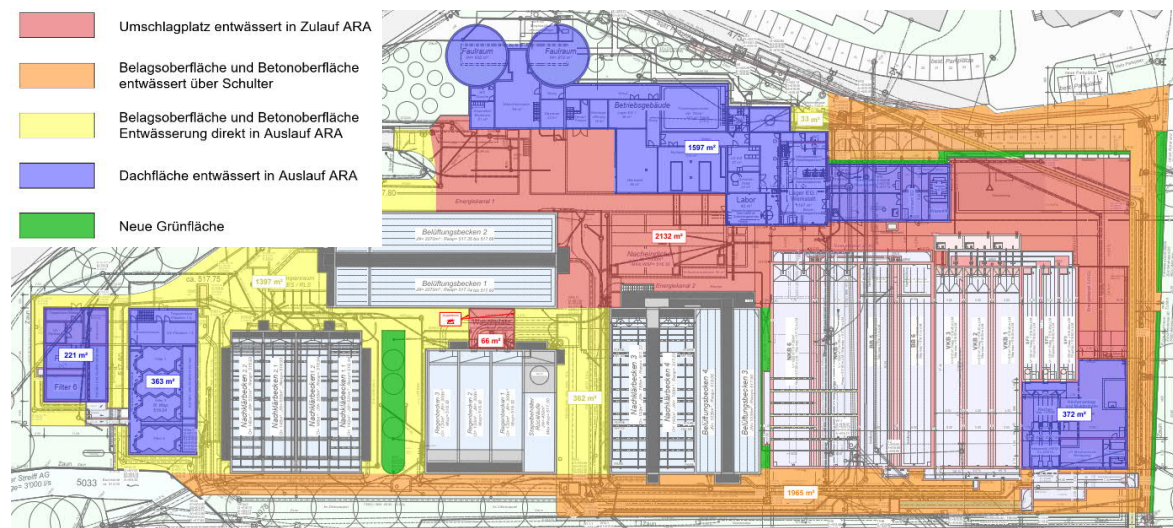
Planausschnitt; Grundriss OG
